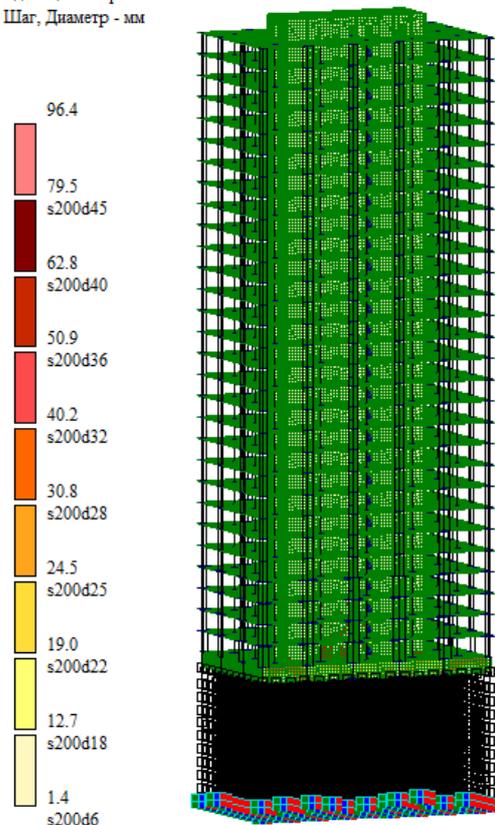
Схема армирования наружной части стен по оси ОХ
